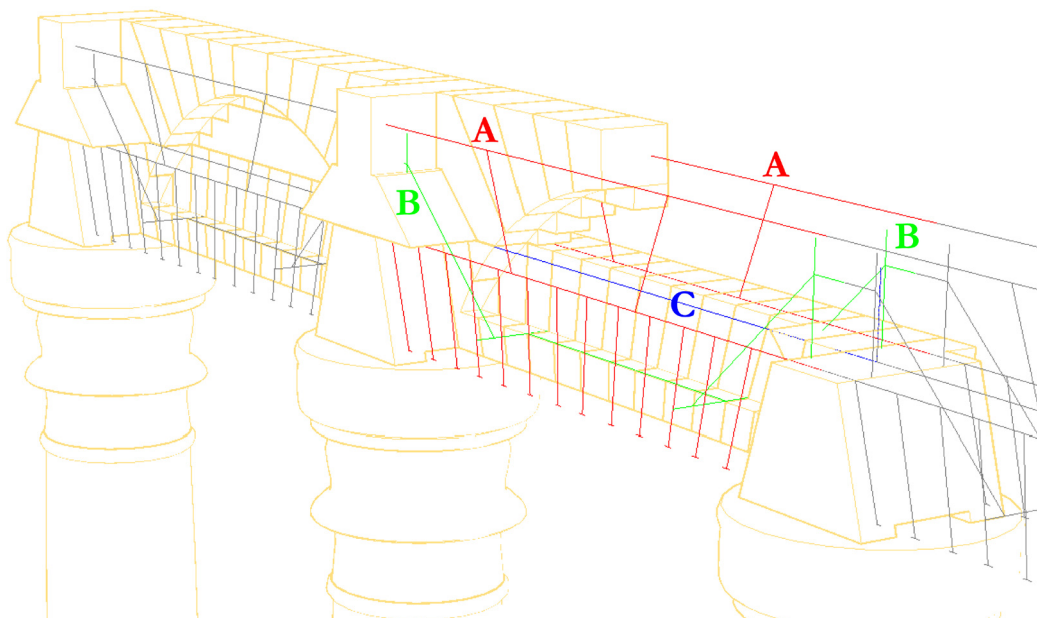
Spaccato prospettico del sistema di piattabande armate del pronao.
